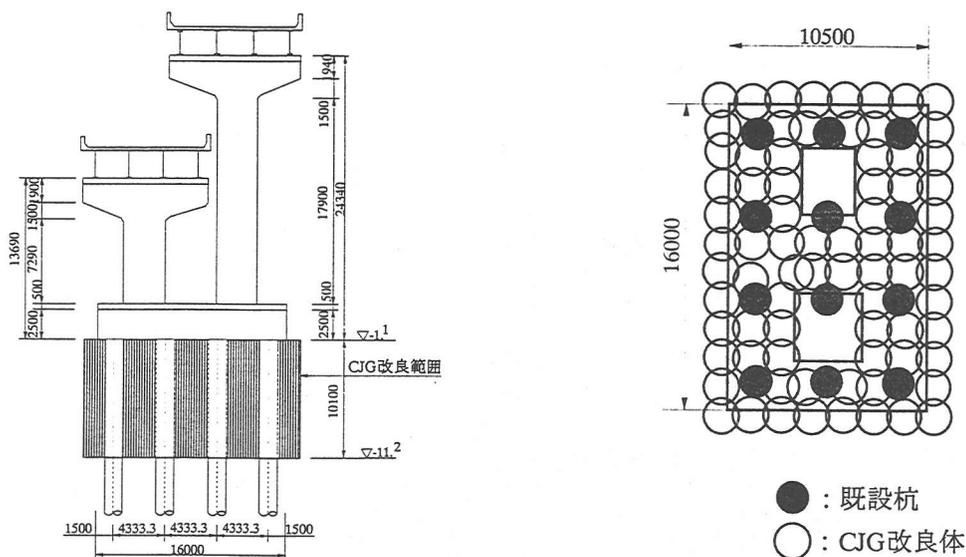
地盤改良工法（C J G工法）の構造一般図(P94)
